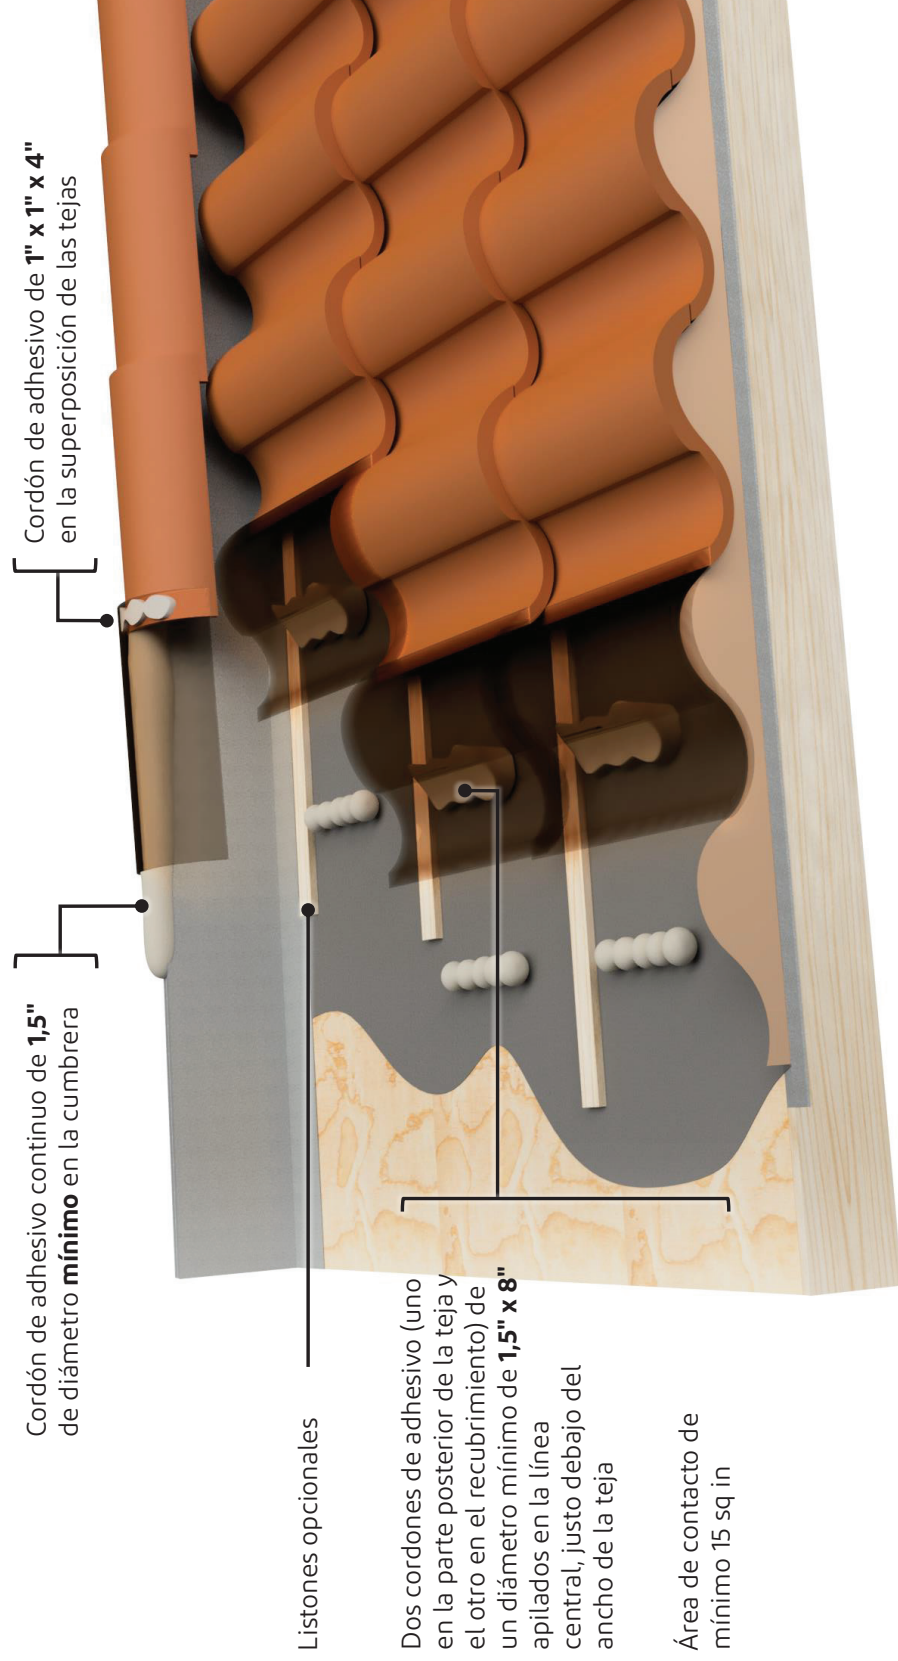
Colocación de adhesivo INDEPENDIENTE de perfil alto Vista ensamblada
